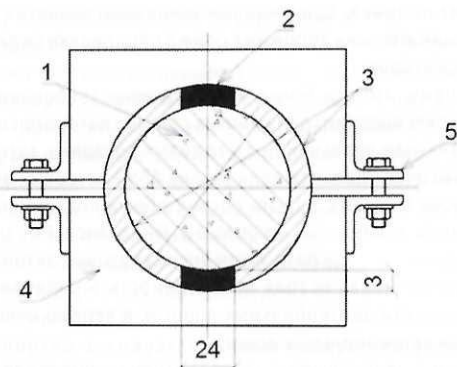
Схема устройства подливки вдоль керна по двум образующим с помощью кондуктора: 1 – бетонный керн; 2 – продольная подливка; 3 – полуобоймы; 4 – хомут, скрепляющий две полуобоймы; 5 – крепление хомутов.
